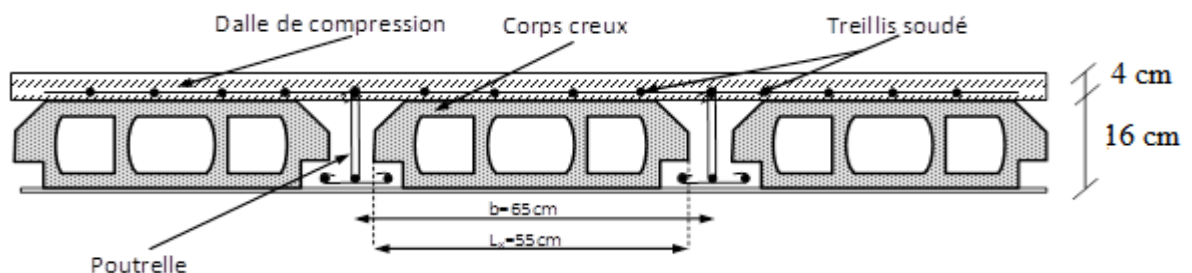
Coupe transversale sur un plancher à corps creux.
